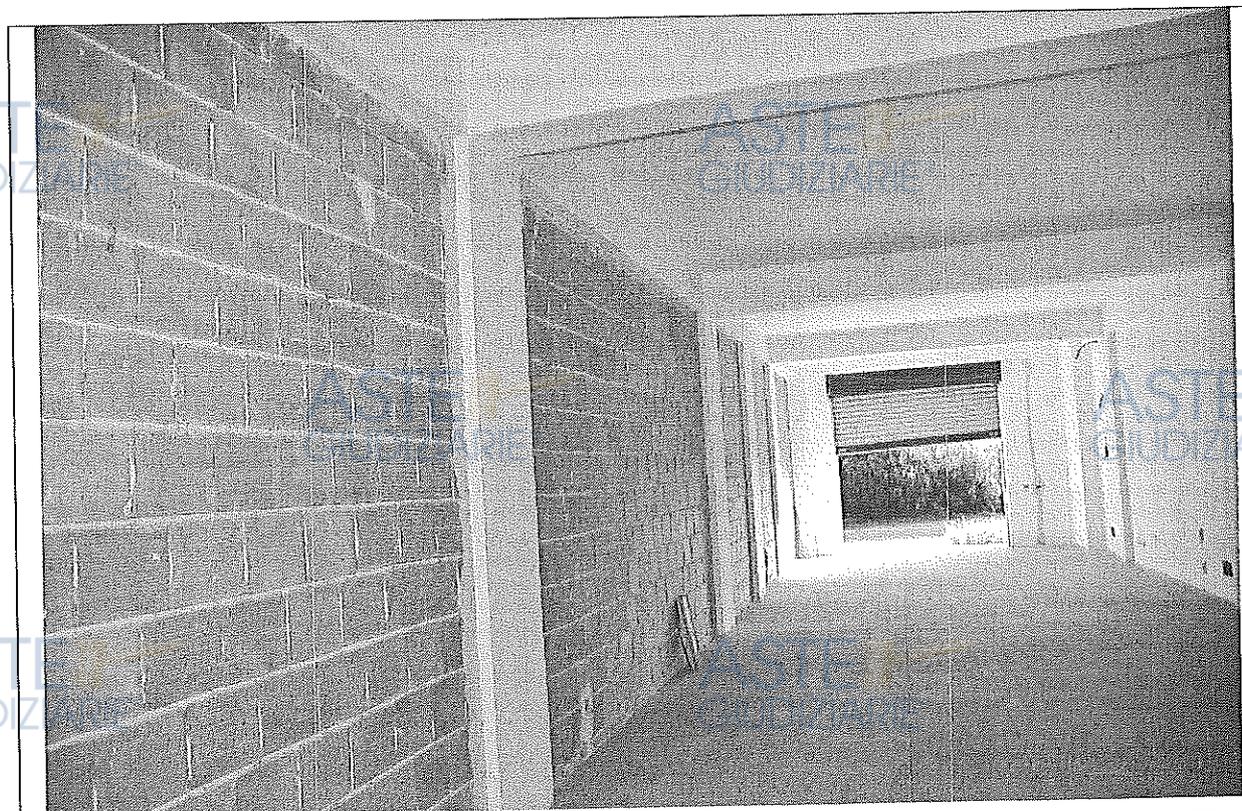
Vista dell'immobile al piano terra sub 4
